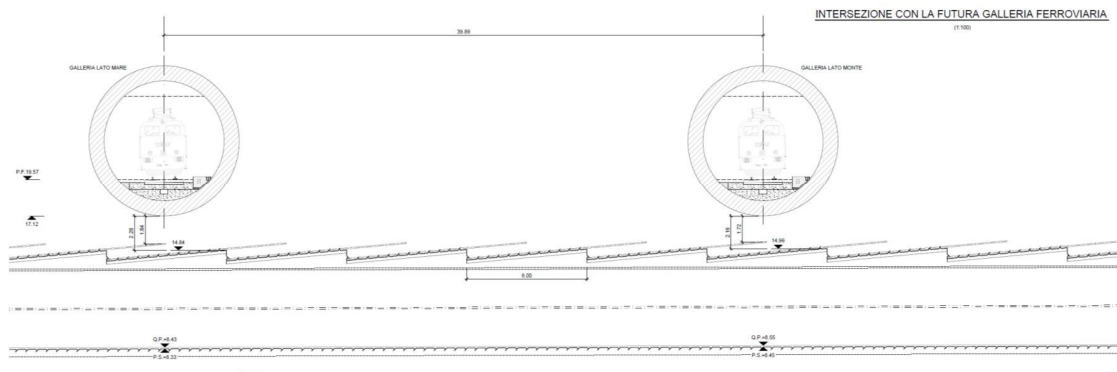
Sezione di intersezione tra la galleria principale Fereggiano e le 2 gallerie ferroviarie di progetto
